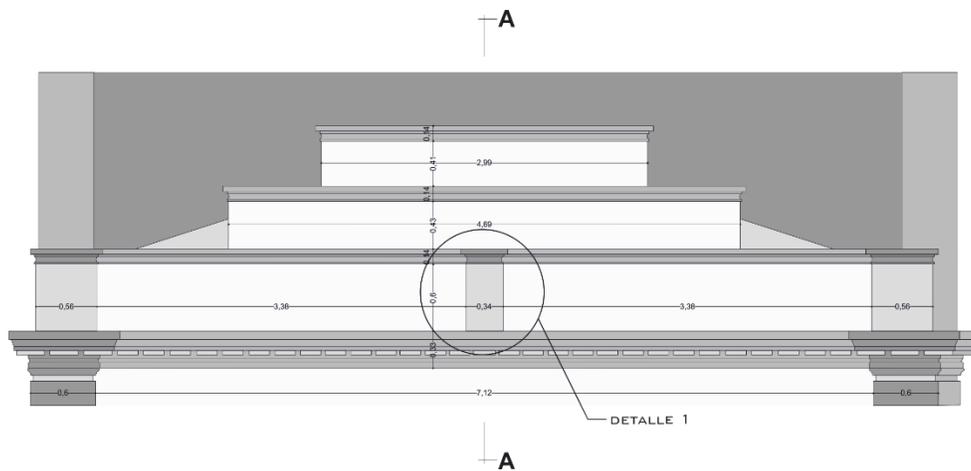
Detalle frontón, Estación del ferrocarril Sur.
